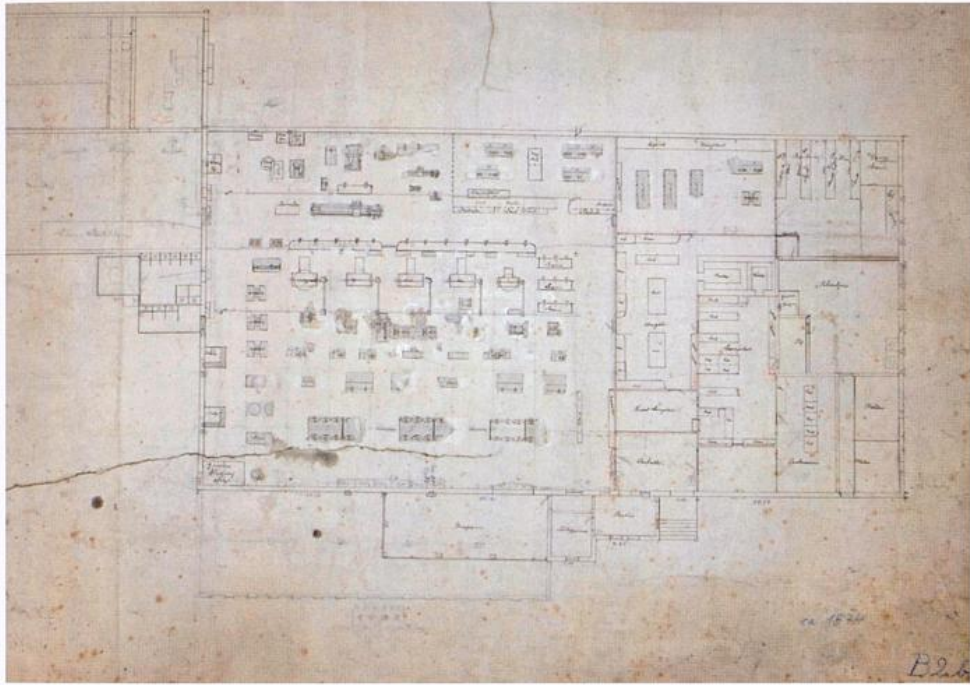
Grundriss der Silberwarenfabrik Koch & Bergfeld, ca. 1874
